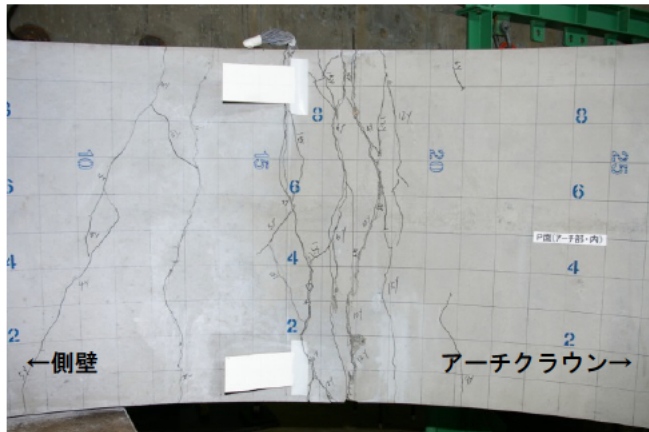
アーチ肩部内側状況（写真-3.1.4の逆側）
